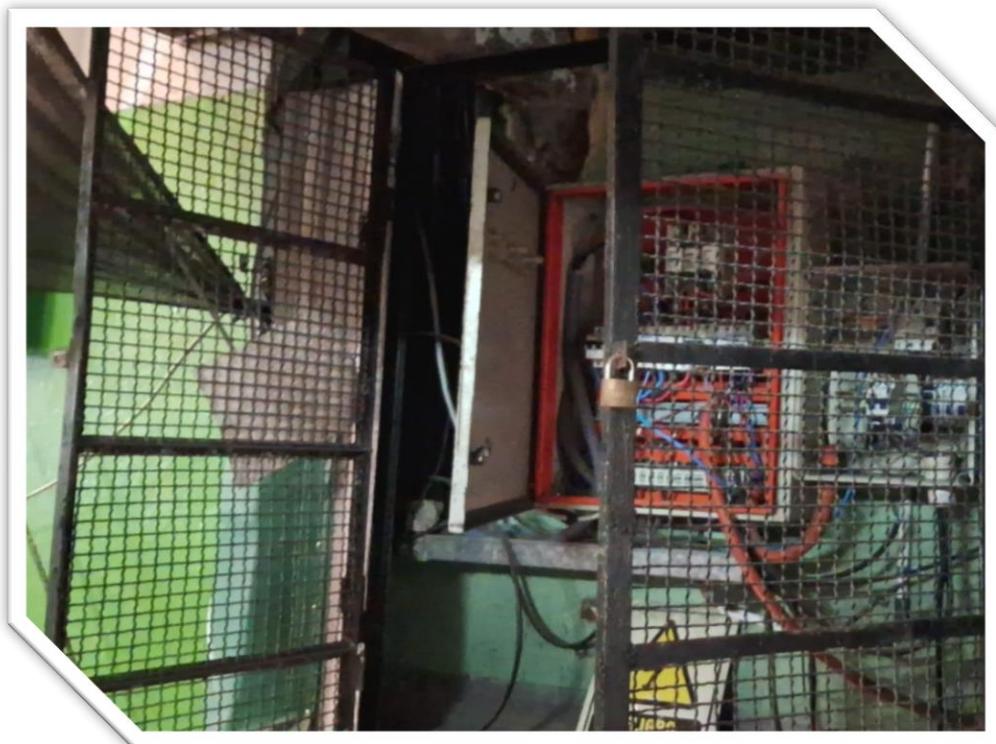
Instalación eléctrica expuesta en la cancha de básquet. Elaboración propia.
